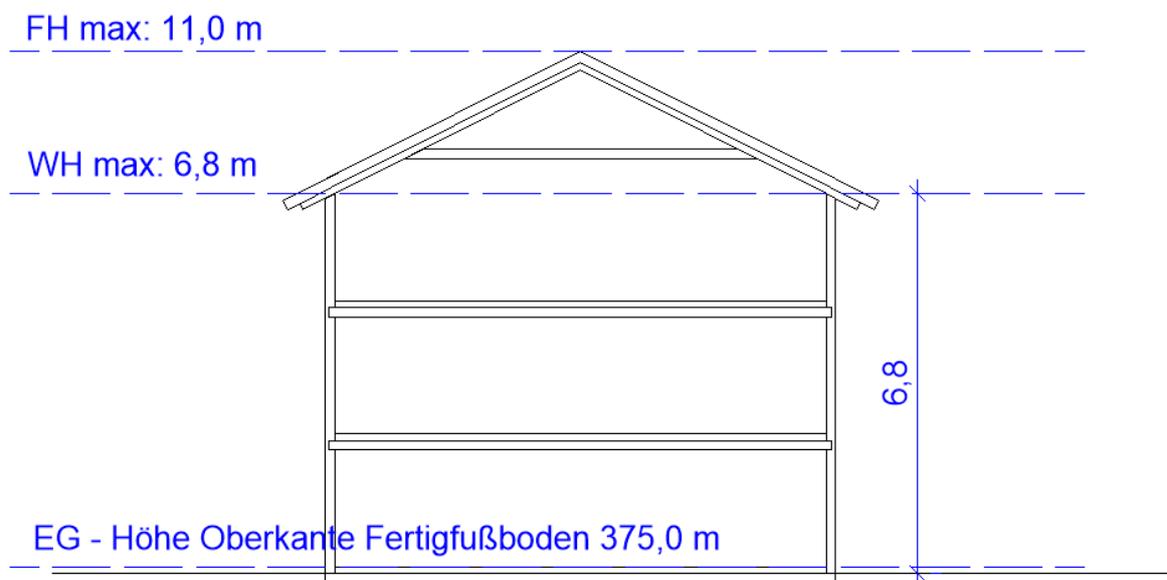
Erläuterung Wandhöhe + Firsthöhe + Oberkante Fertigfußboden (o. M.)
